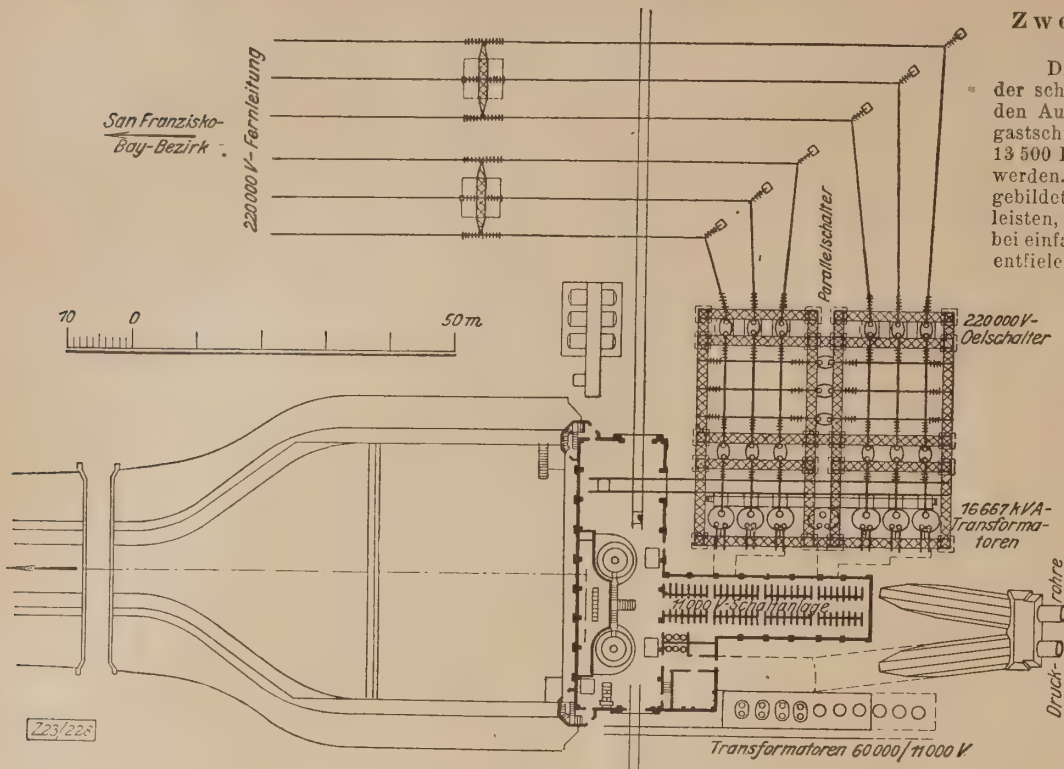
Grundriß des Pit River-Kraftwerkes.
